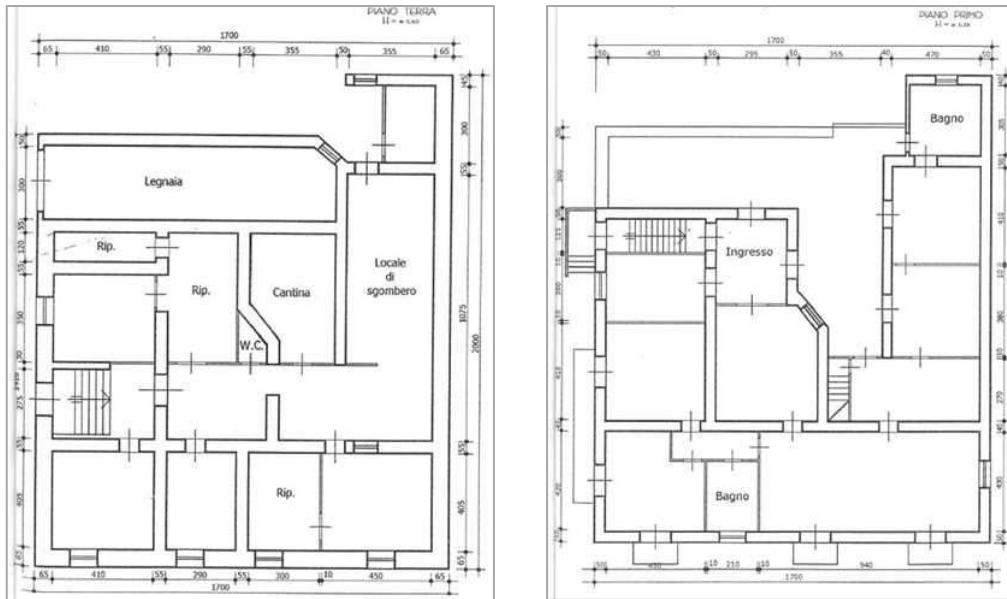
e 6 -Planimetrie stato di progetto (DIA n.246/2004)
